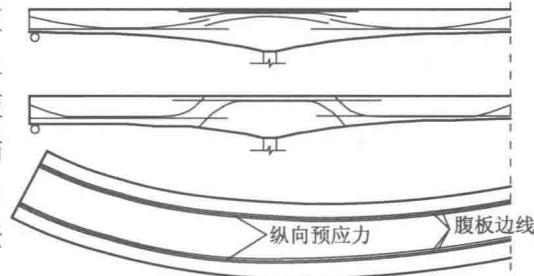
预应力混凝土连续刚构桥纵向预应力布置示意图
